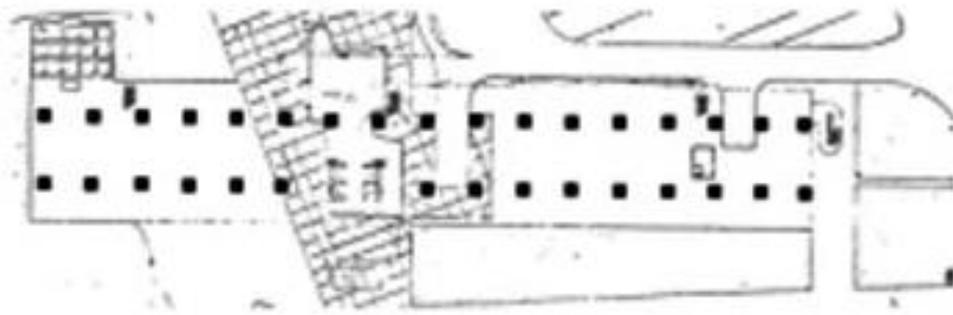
Planta baja edificio de vivienda Marsella. Fuente Internet. S/E
